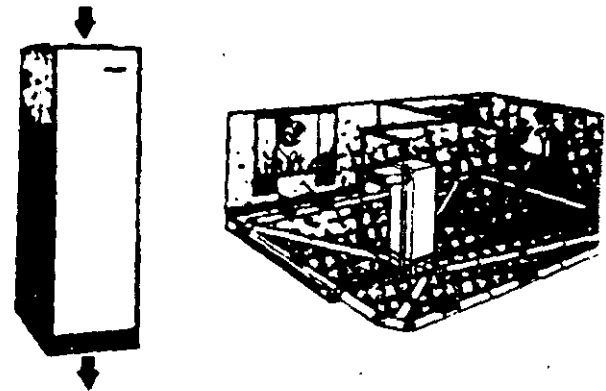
Calefactor bajo (Cortesía de Bard Manufacturing Company)
